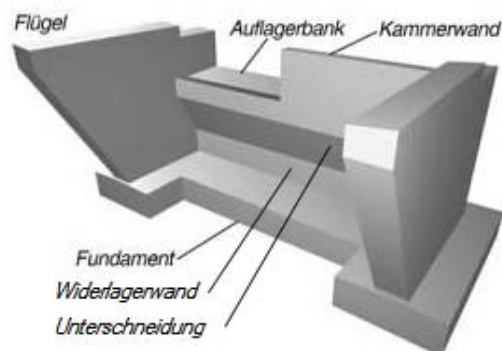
Bauteile eines Widerlagers (MEHLHORN 2007)
